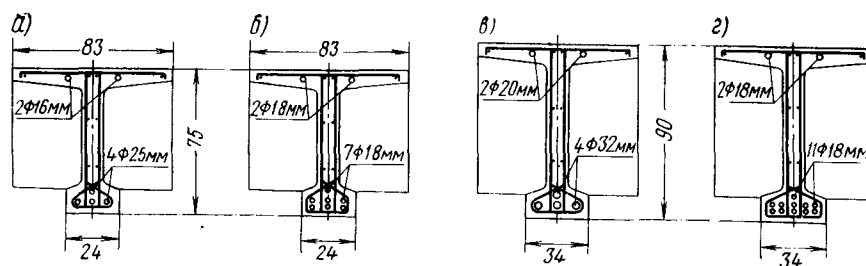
Поперечное сечение балок со стержневой арматурой длиной: а, б — 11,36 м; в, г — 16,76 м
